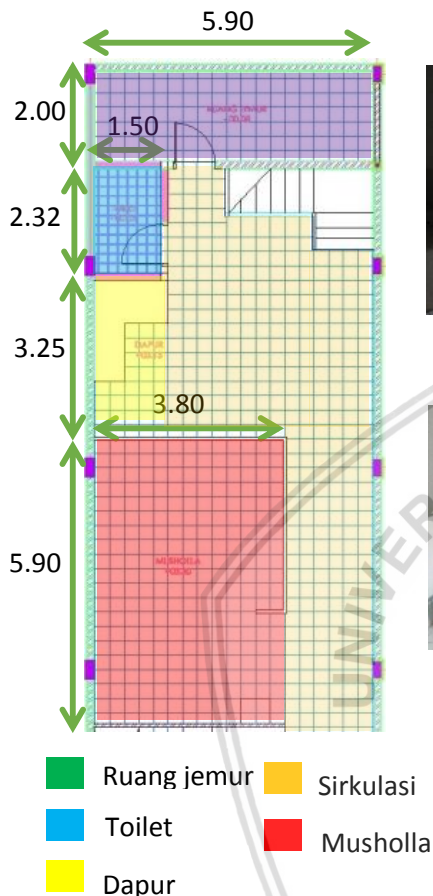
Denah Ruang Servis Lantai 1 Objek C
